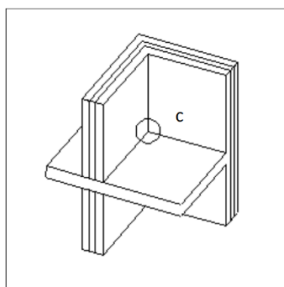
Ponte térmica pontual derivada da interseção de três elementos da envolvente (duas paredes e um pavimento) [51]
